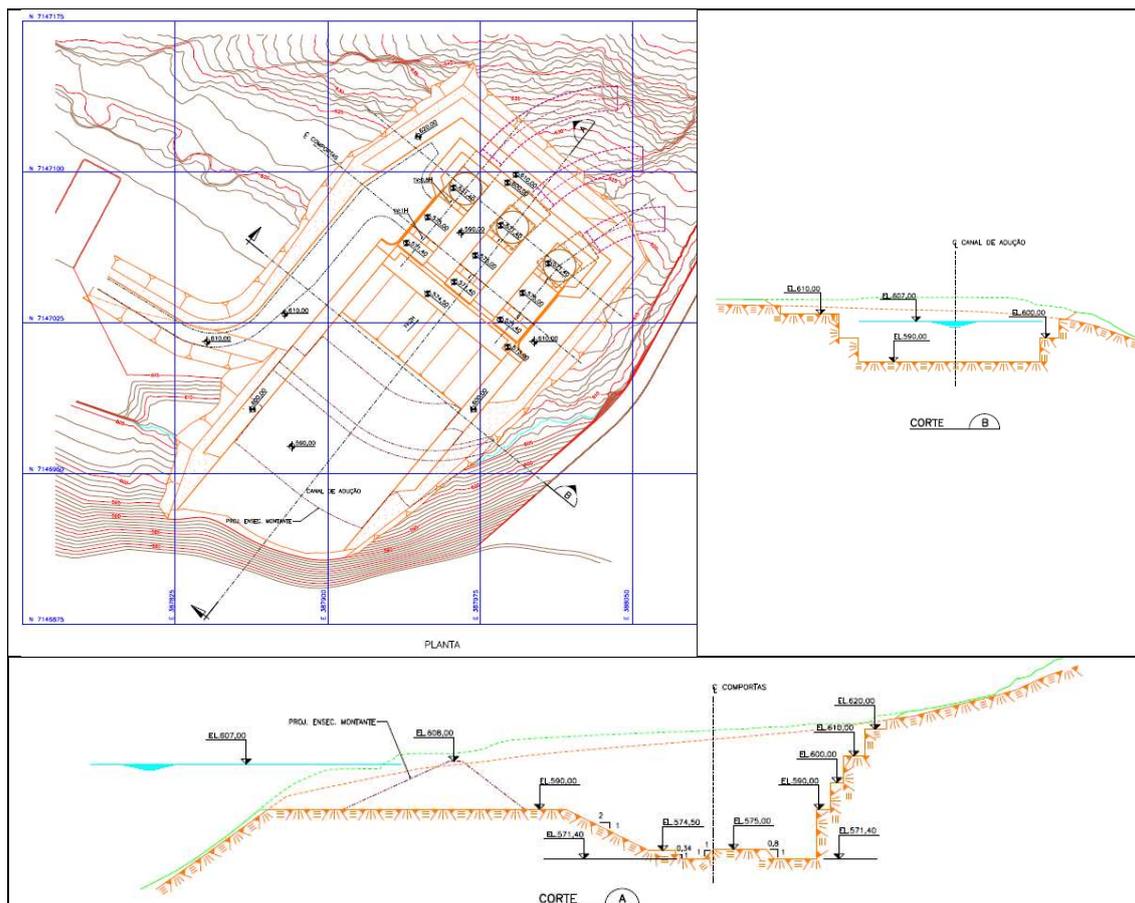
Planta e cortes das escavações do Canal de Adução
